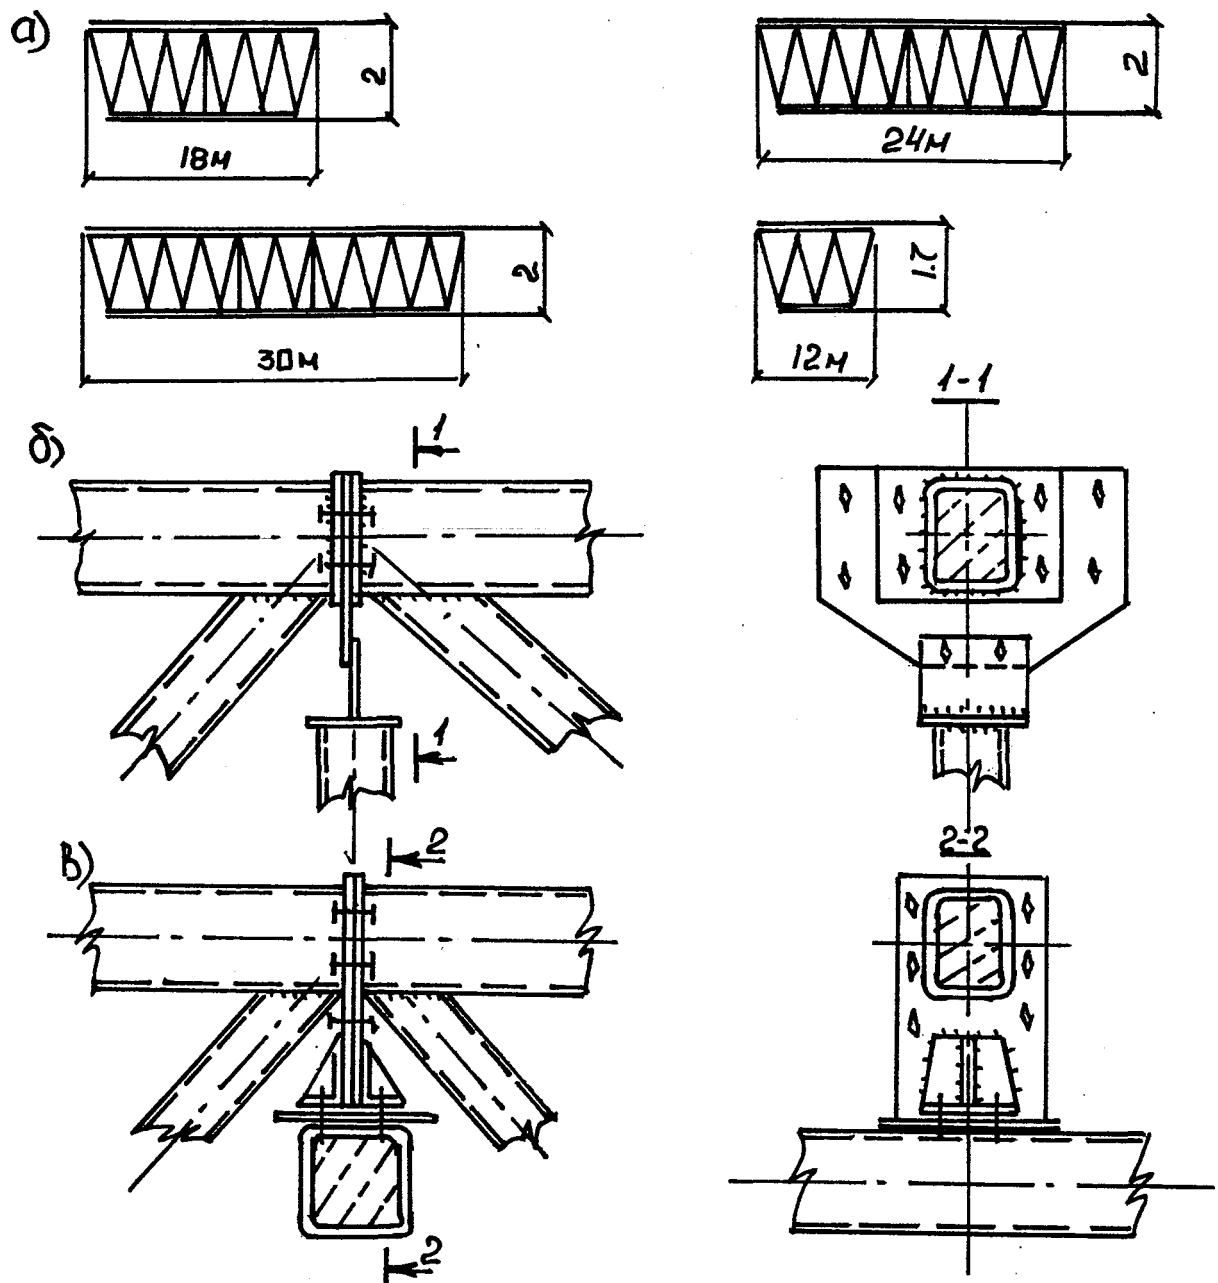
Схемы конструкции металлобетонных ферм:
